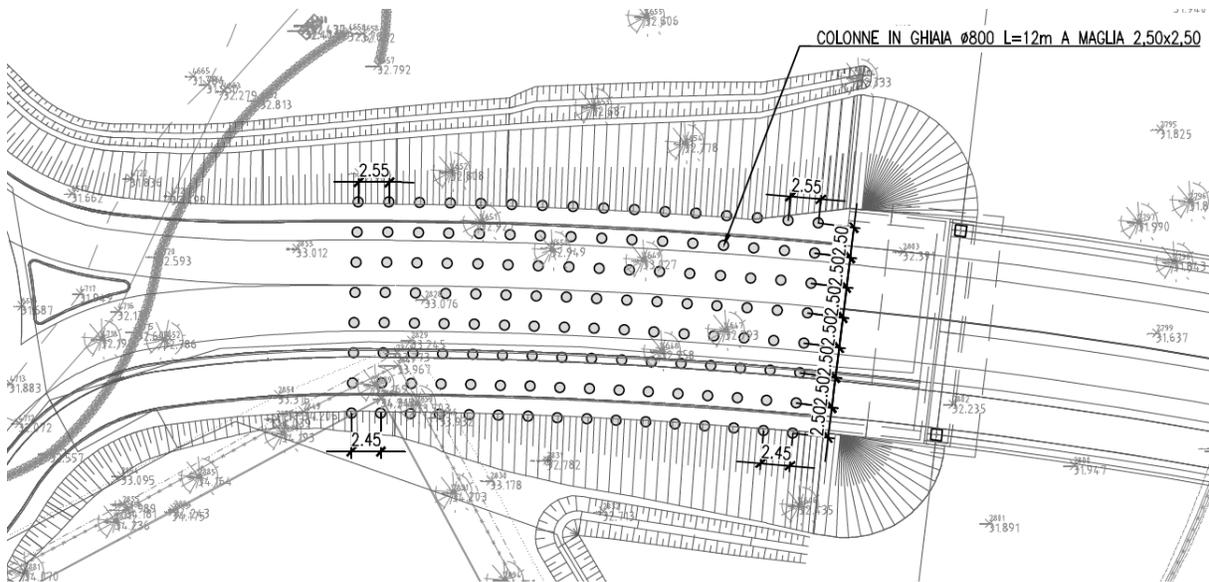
Planimetria intervento colonne in ghiaia per rilevato A01
